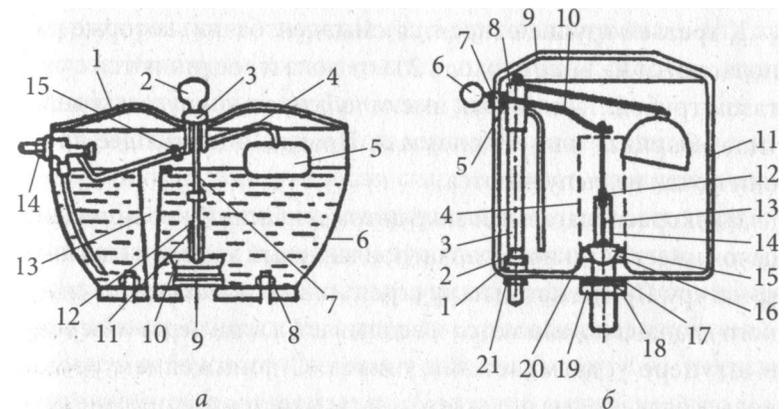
Конструкции смывных бачков: *а* — смывной бачок с боковой подводкой воды с верхним пуском: 1 — крышка бачка; 2 — кнопка пуска; 3 — гайка; 4 — рычаг клапана; 5 — поплавок; 6 — корпус; 7 — тяга; 8 — крепление к унитазу; 9 — седло; 10 — клапан; 11 — крепление клапана; 12 — направляющие; 13 — перелив; 14 — подвод воды; 15 — шайба; *б* — смывной бачок с нижней подводкой воды: 1 — резиновая прокладка и металлическая шайба; 2, 5, 21 — контргайки; 3 — стойка; 4 — перелив; 6 — ручка; 7 — втулка механизма спуска; 8 — вертикальный поплавковый клапан; 9 — крышка бачка; 10 — рычаг; 11 — корпус бачка; 12 — втулка; 13 — тяга; 14 — дуга; 15 — груша; 16 — резиновая прокладка седла; 17 — резиновая прокладка; 18 — металлическая шайба; 19 — гайка седла; 20 — седло
